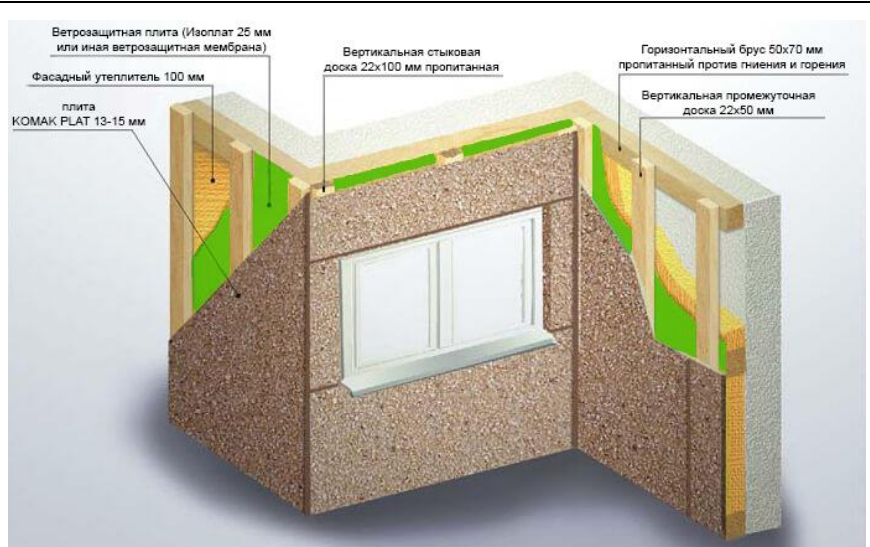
Вентилируемый фасад КОМАК PLAT и ветрозащитная плита ИЗОПЛАТ.
